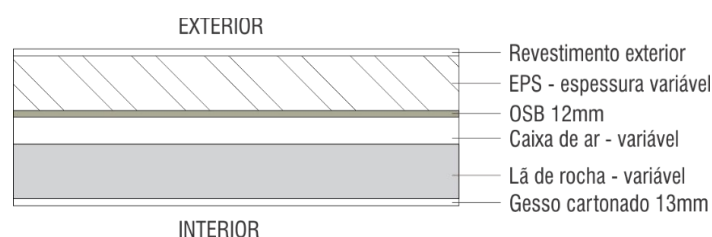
Detalhe esquemático das camadas utilizadas nas paredes exteriores.
